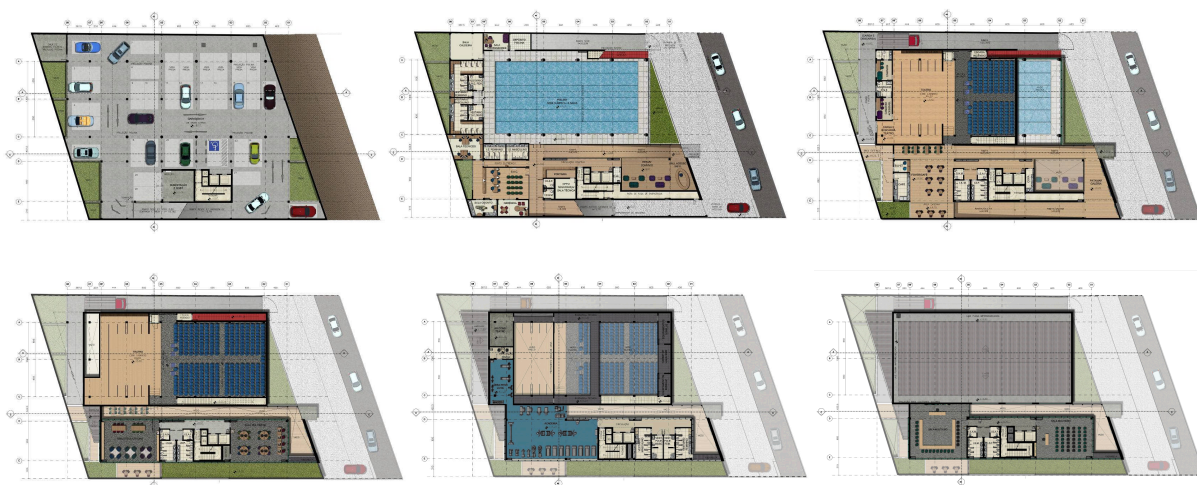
Plantas dos pavimentos do edificio sede SESC Canoas, RS.
